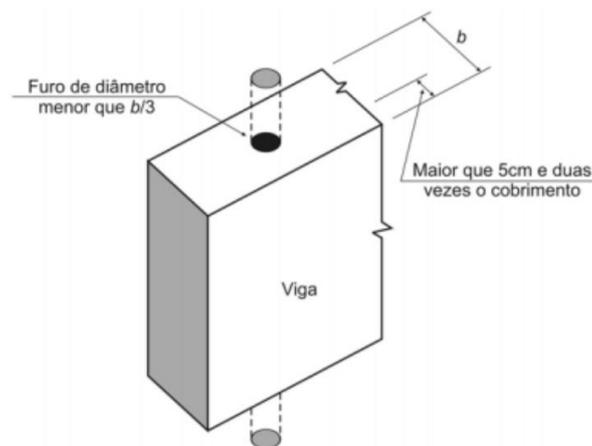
Furos que atravessam a viga (FONTE: NBR 6118)
